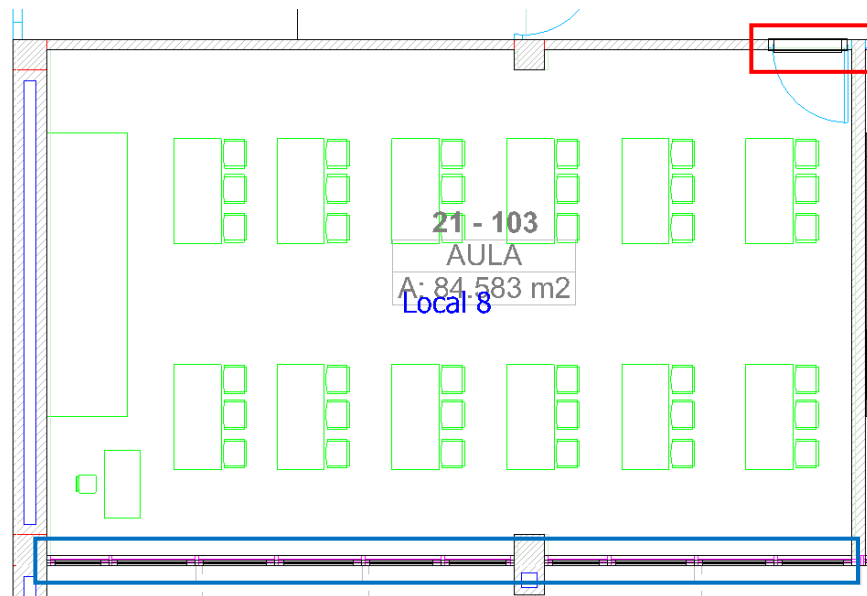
Ventanas y puerta de un espacio interior de la planta 1 de la edificación.
